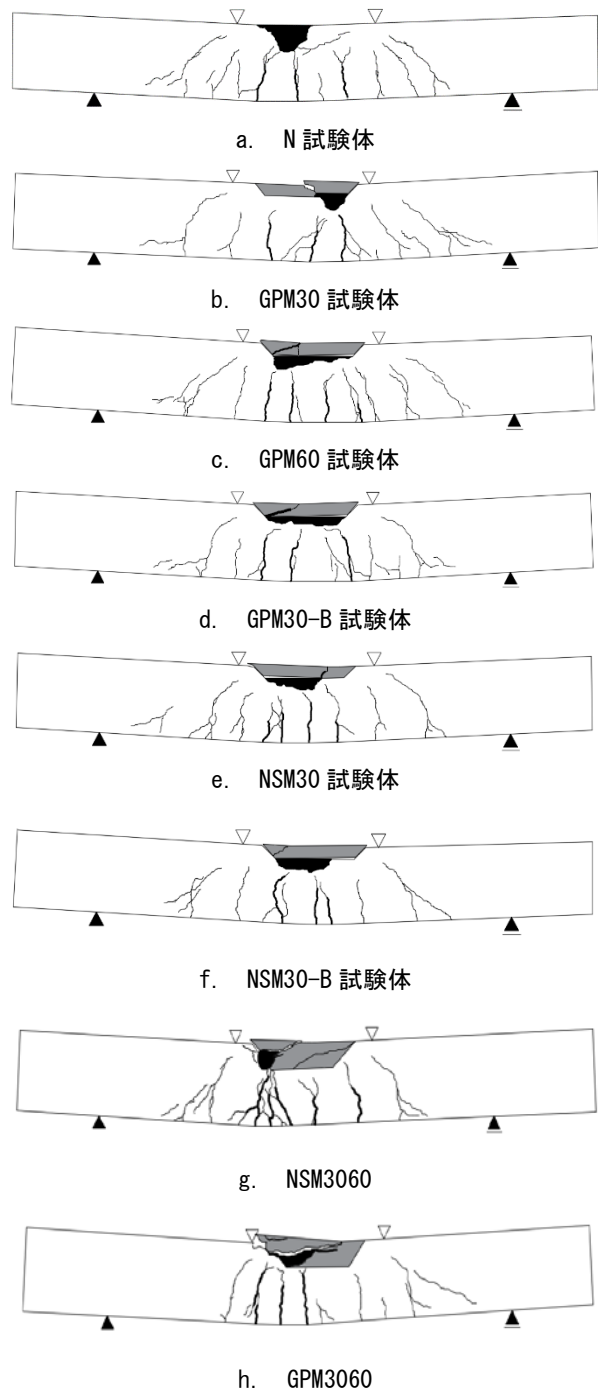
ひび割れおよび破壊状況(曲げ試験終了時)
